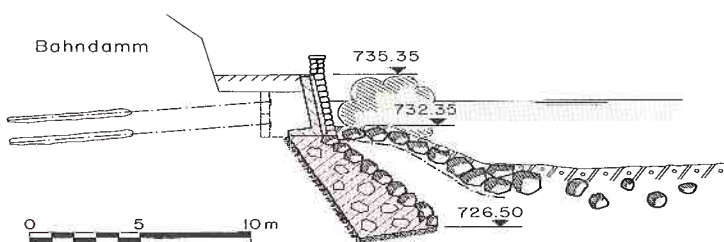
Hauptschutzelement C: Gewichtsmauer mit aufgesetzter Winkelstützmauer, sekundärer Blockwurf.
